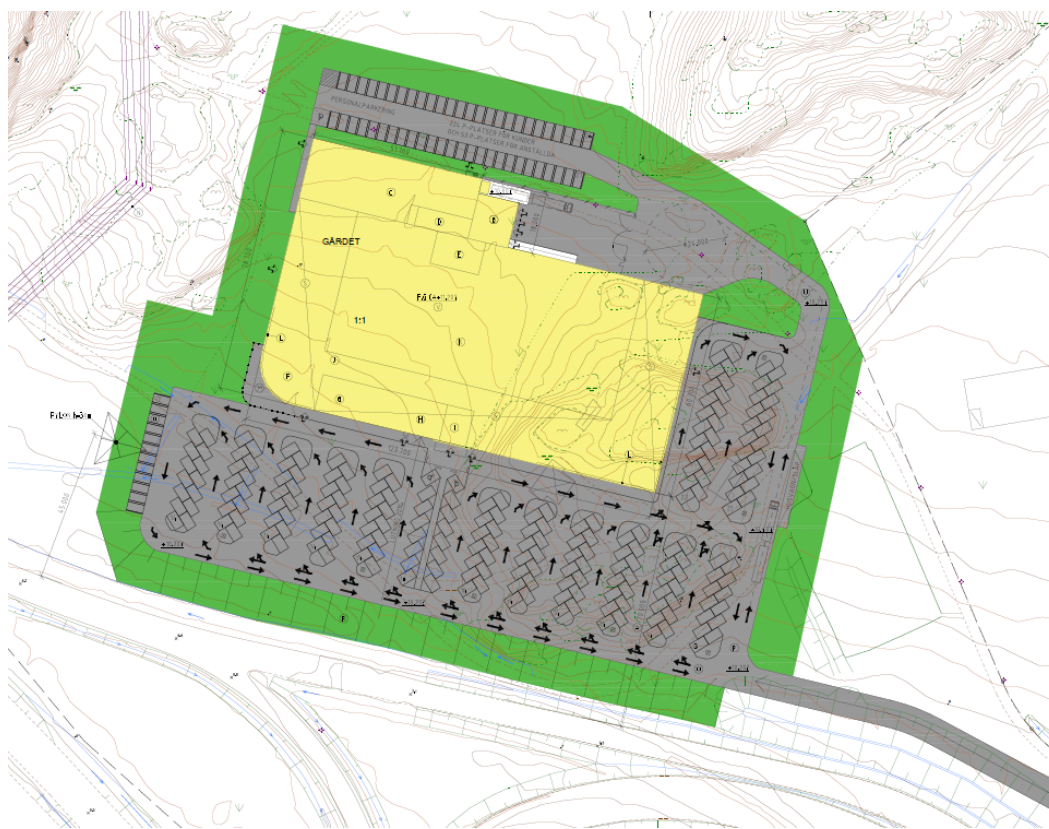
Illustration från planansökan med förslag på placering av byggnad och parkering.
